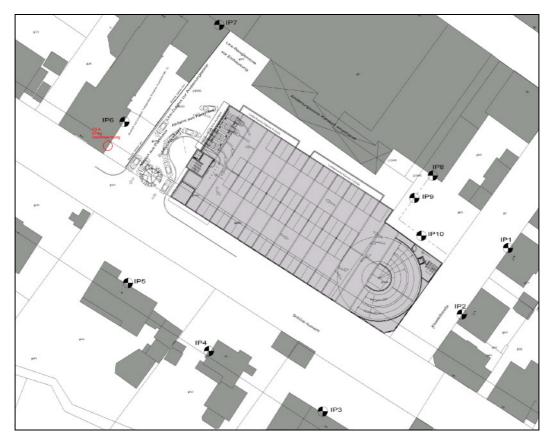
Lageplan der untersuchten Immissionsaufpunkte (IP)<sup>32</sup>
